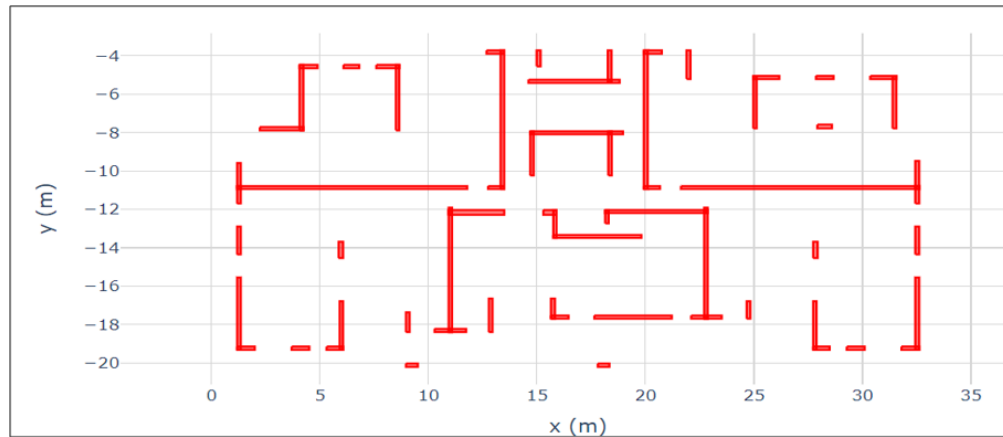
Plano arquitectónico de un edificio típico chileno.
